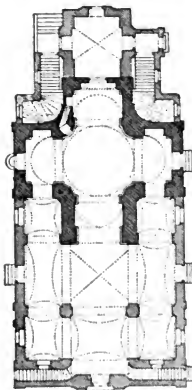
Chlum. Grundriss der Kirche.
